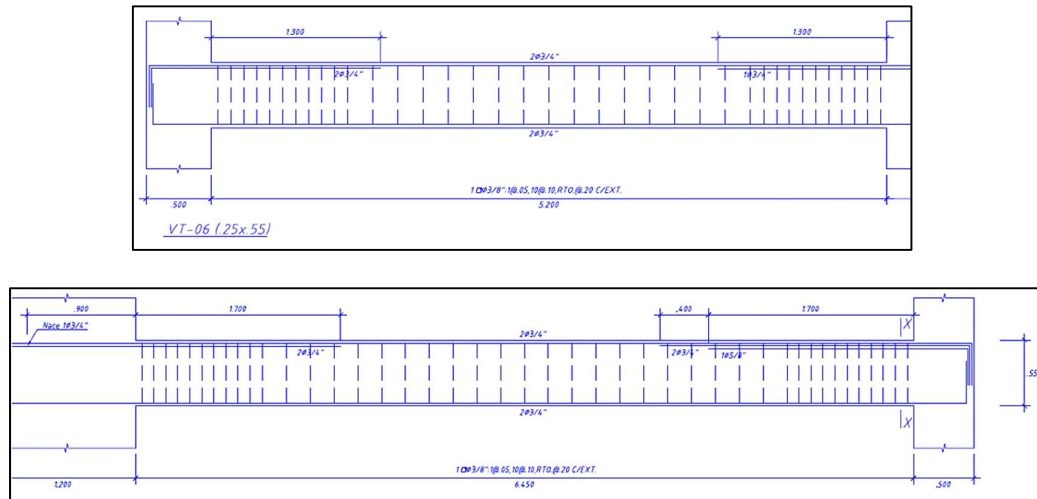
Vista de perfil viga VT-06 (Por tramos)
